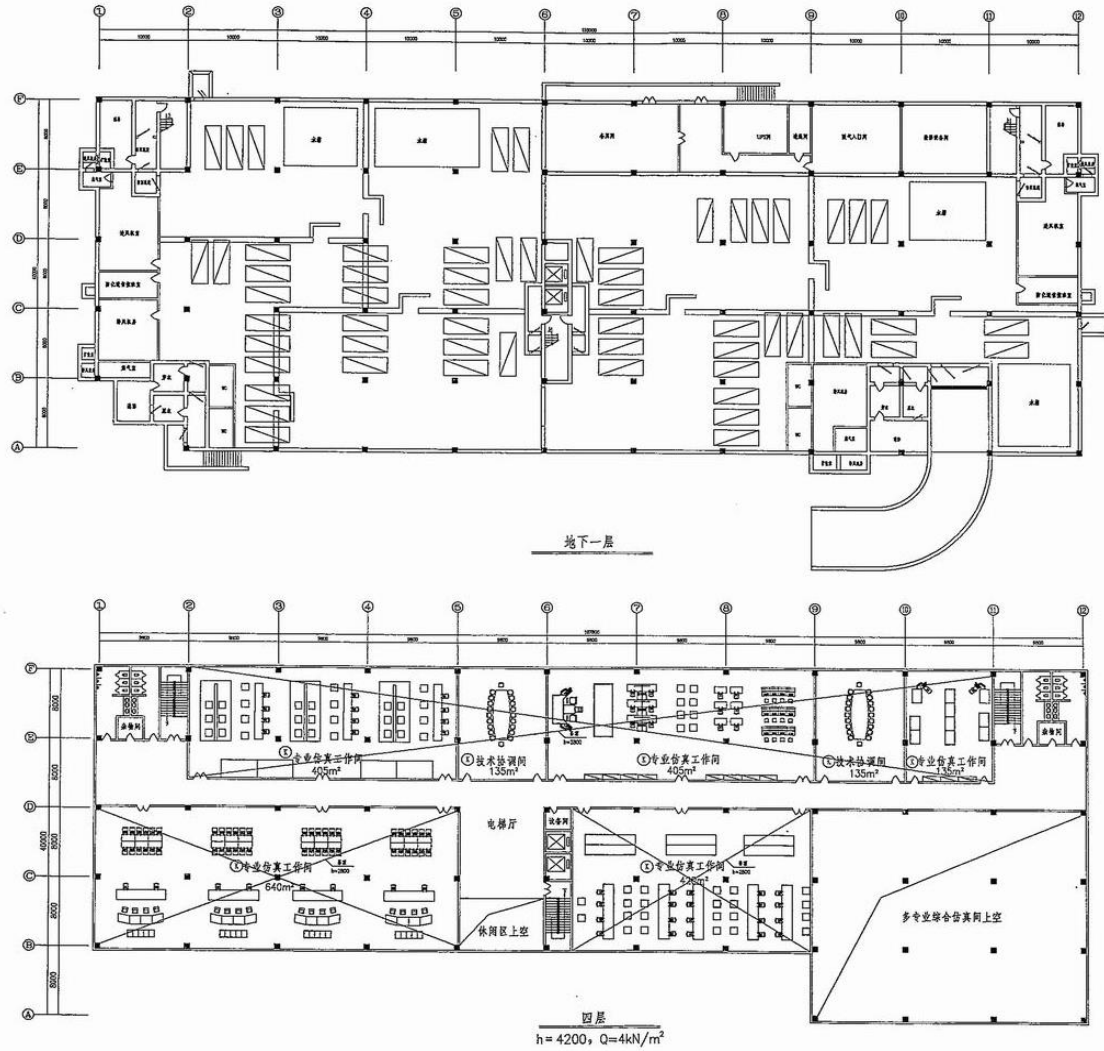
103 号科研办公楼四层、地下一层平面布置图
